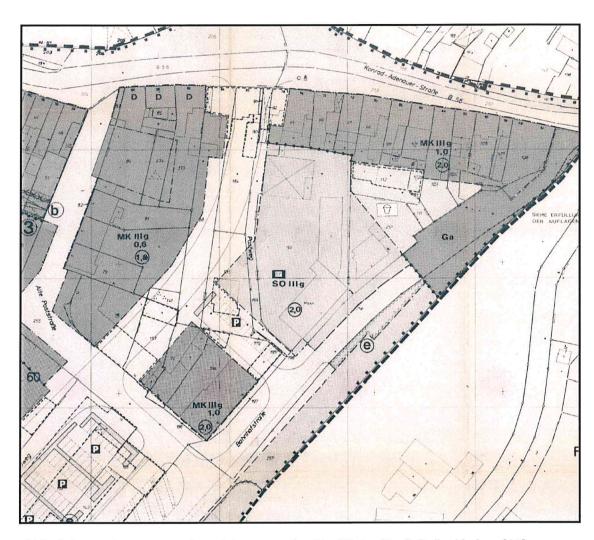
Auszug aus dem Bebauungsplan Nr. 35 der Stadt Geilenkirchen [19]
